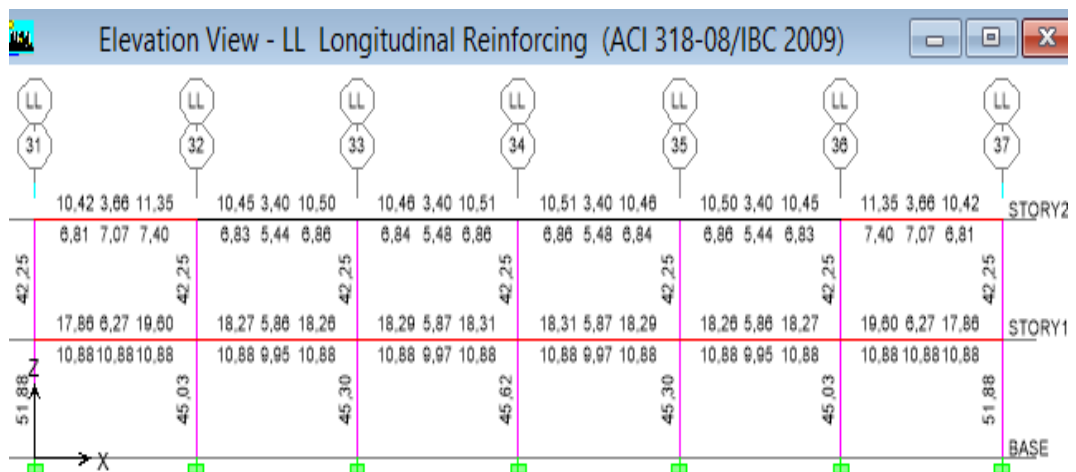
Acero en Vigas y Columnas en el Pórtico LL – C. Quirúrgico- (NEC-11)
